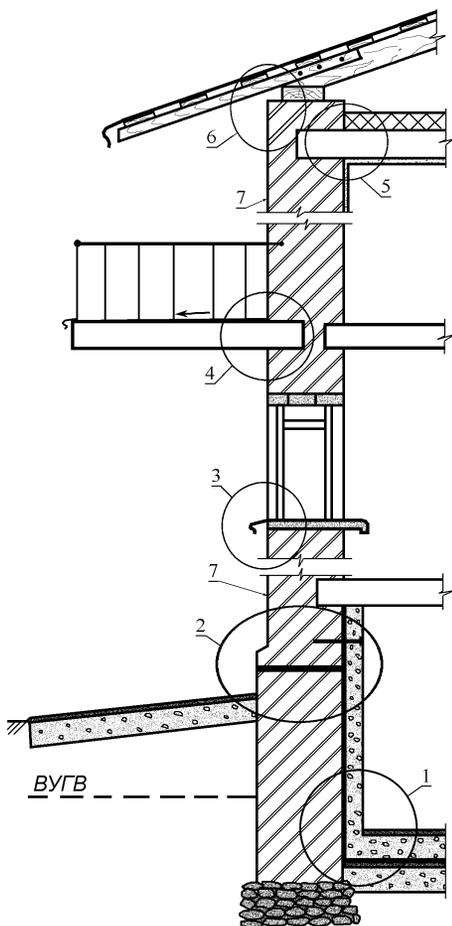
Основные зоны и причины увлажнения наружных стен зданий:
